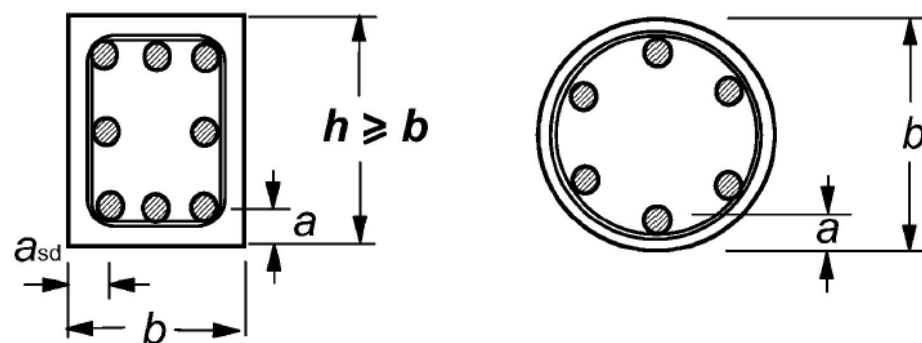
Secțiuni transversale ale elementelor structurii care arată distanța nominală între axă și suprafață
